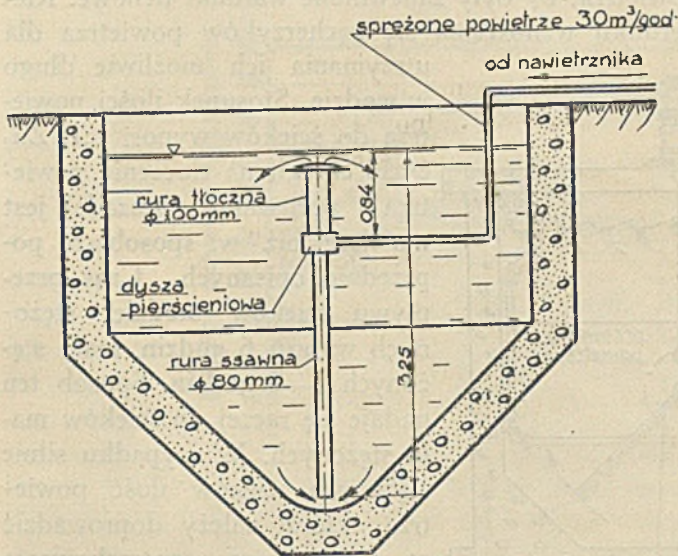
Nawietrzanie ścieków sposobem Kessenera
